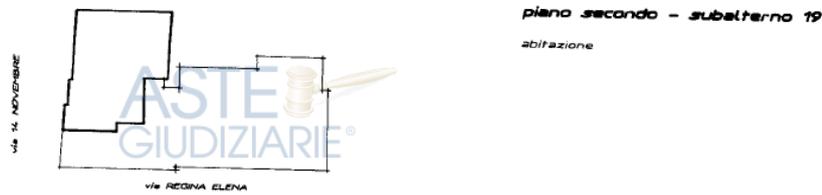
Estratto dall'elaborato planimetrico - non in scala - in atti al Catasto Fabbricati, con indicazione della posizione dell'unità immobiliare sub. 19
